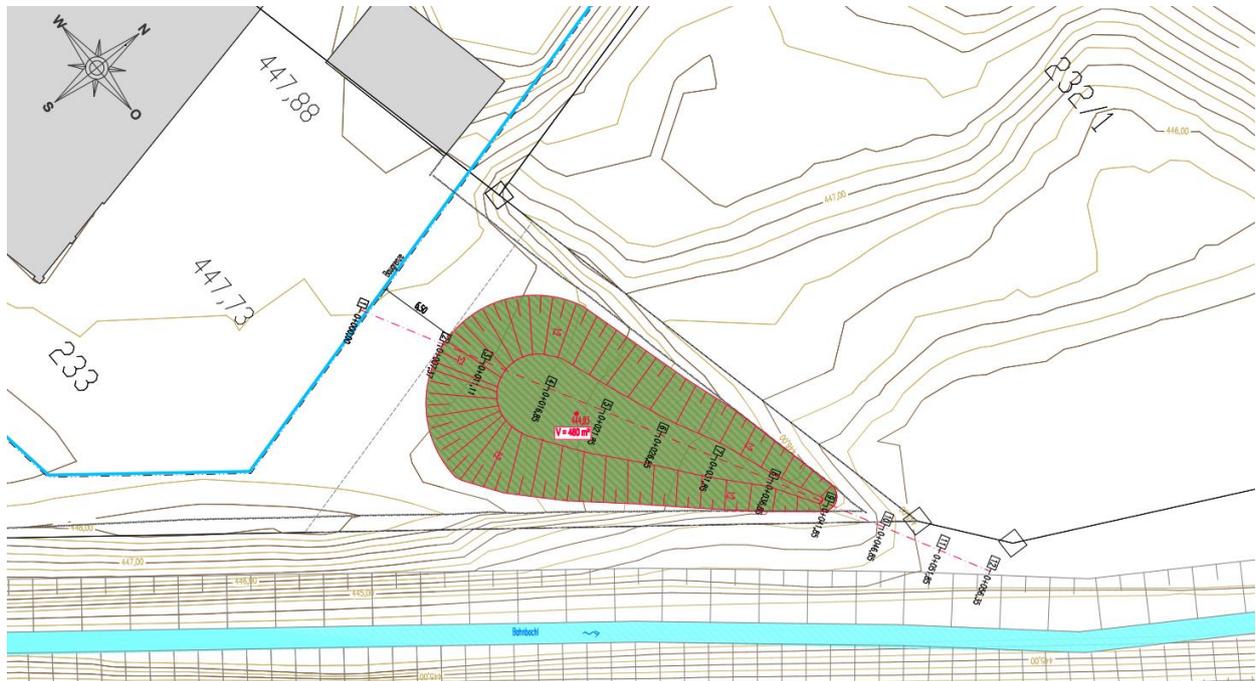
Lageplan Ausgleichsmaßnahme Erdbecken
